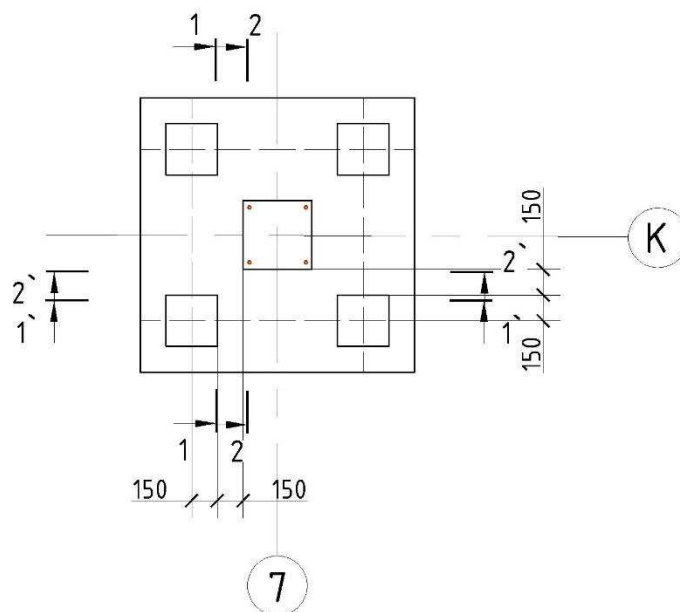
Схема к расчету ростверка на изгиб
